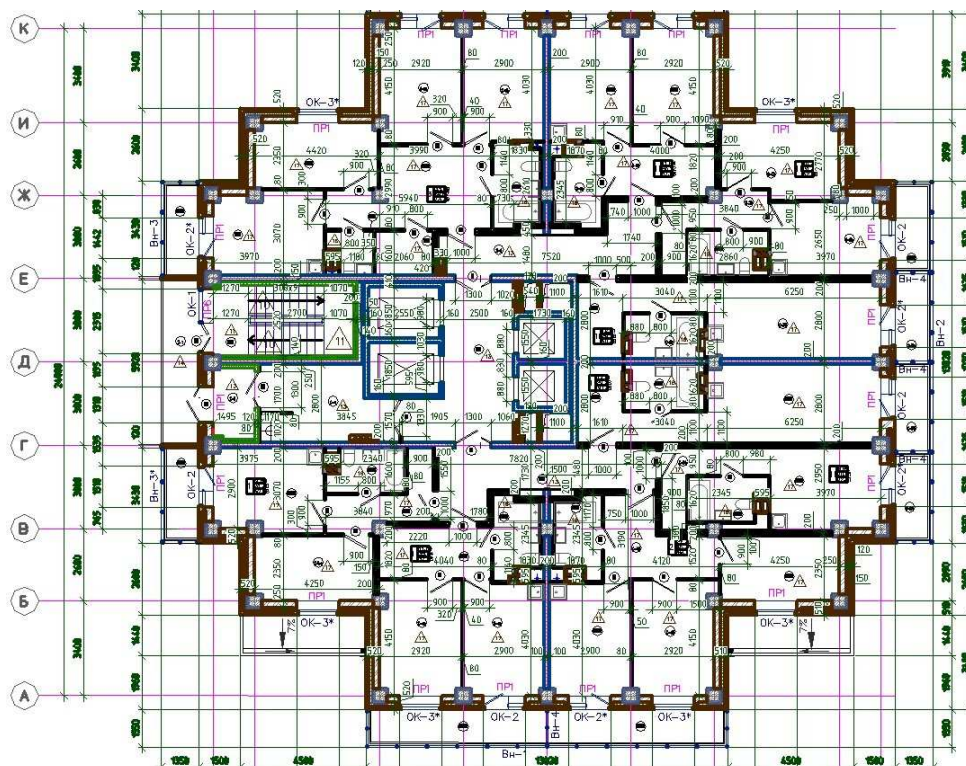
Рассматриваемая плита перекрытия типового этажа
